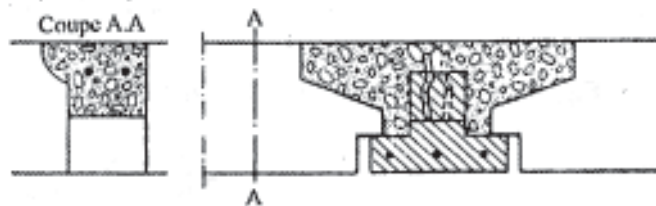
Plancher à poutrelles préfabriquées en béton armé sans dalle de répartition
